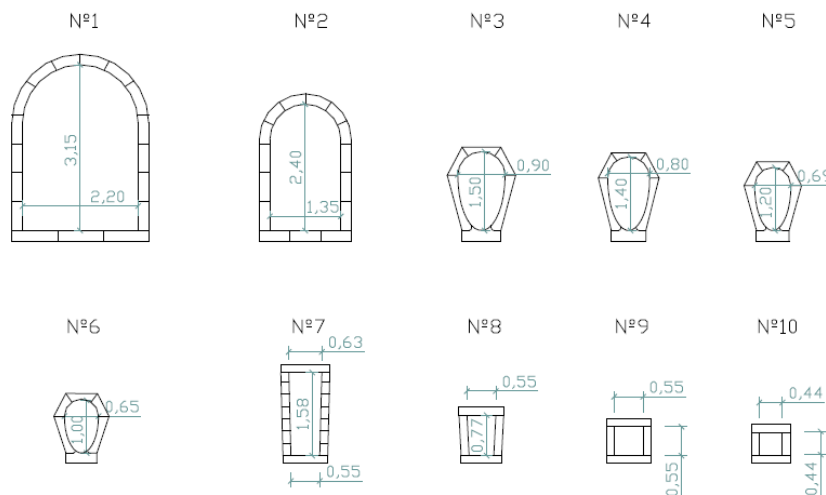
"Canos atuais" segundo o projeto de Ressano Garcia (1884) Construção em cantaria ou alvenaria de tijolo -tipo de coletores implantados em Lisboa em 1884 (Matos, 2003).
